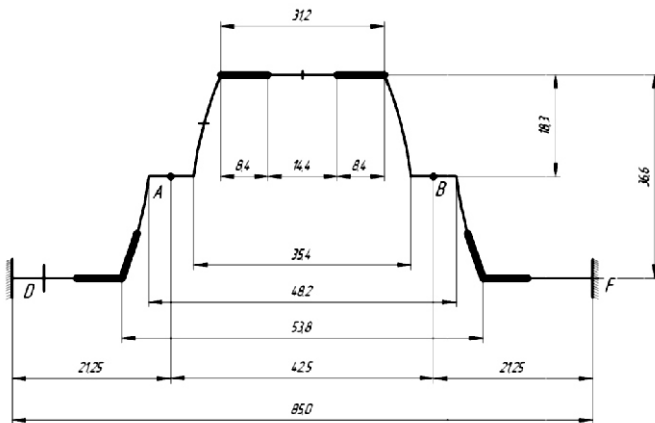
Схема поперечного сечения рамы из профиля шпунта Л-7
